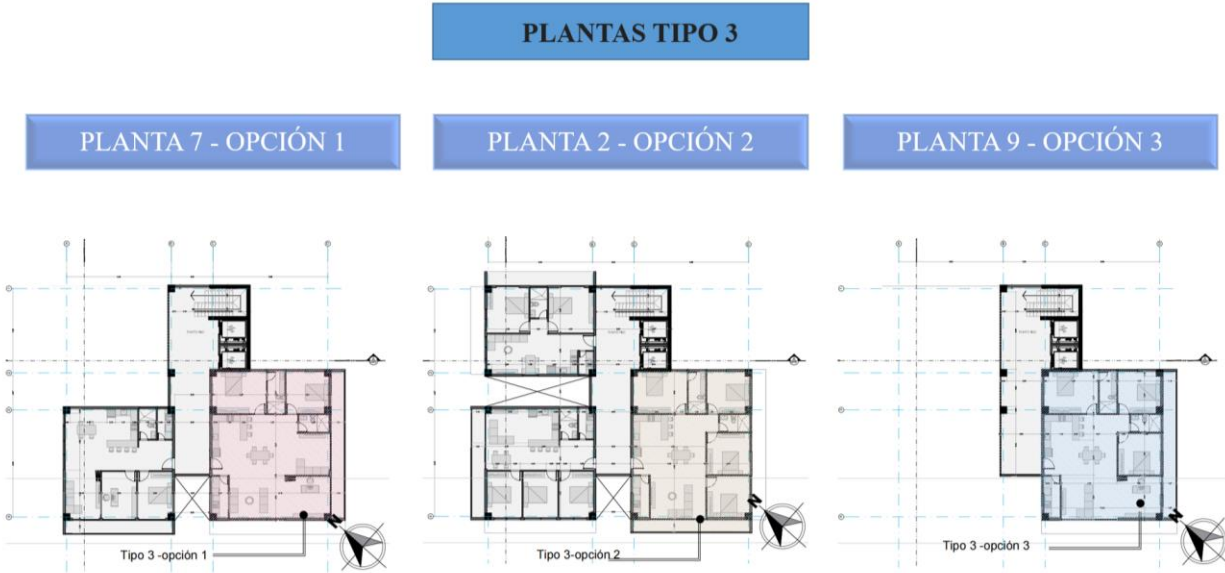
Plantas y cortes vivienda tipo 3 – Zonificación
